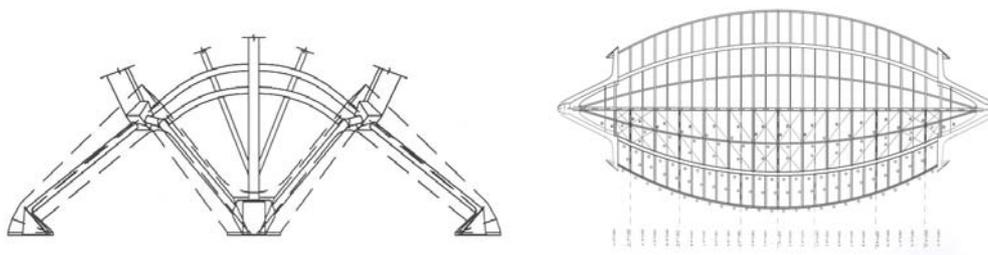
Estructura metálica de la cubierta del Hemisférico.
